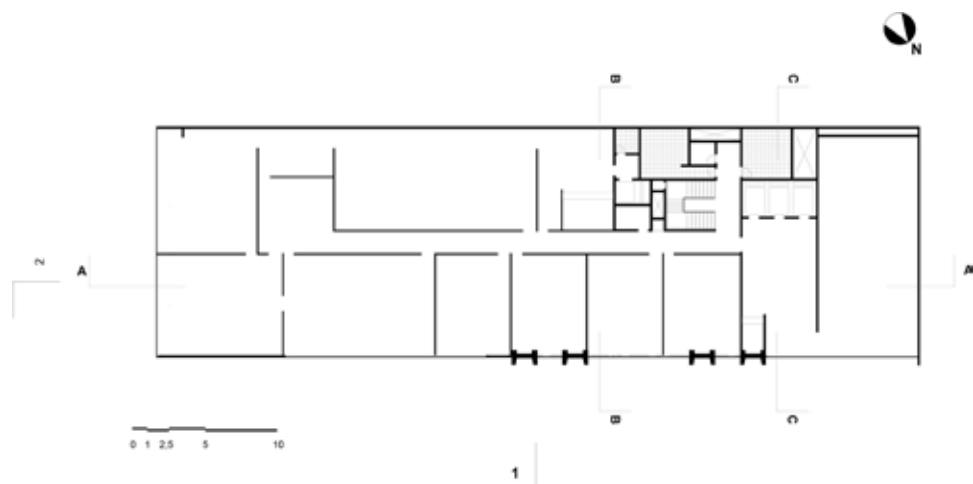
Planta 3º e 4º pavimentos do BEC. Desenho com base no projeto original (1968), Neudson Braga.
